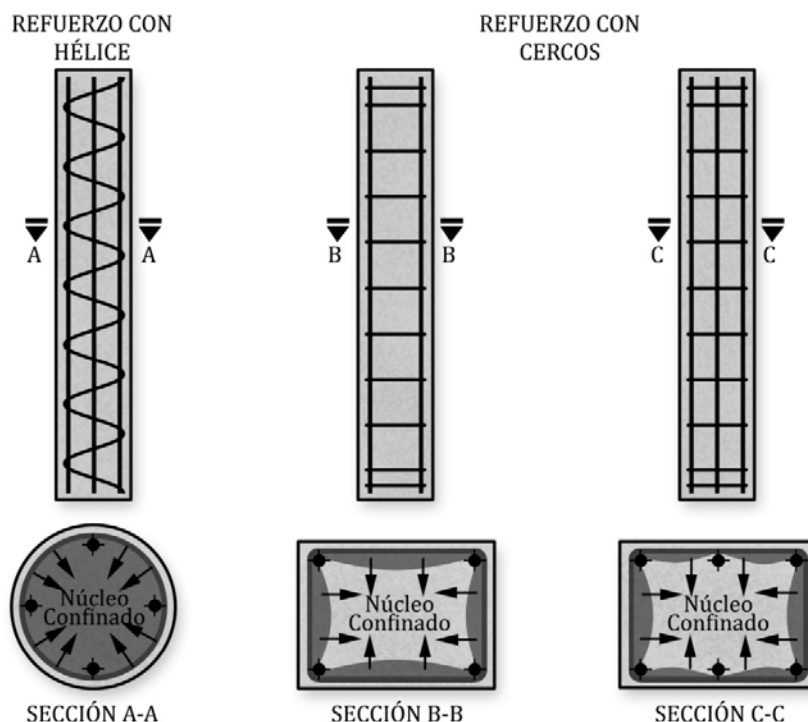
Efecto del refuerzo transversal en el confinamiento del hormigón
